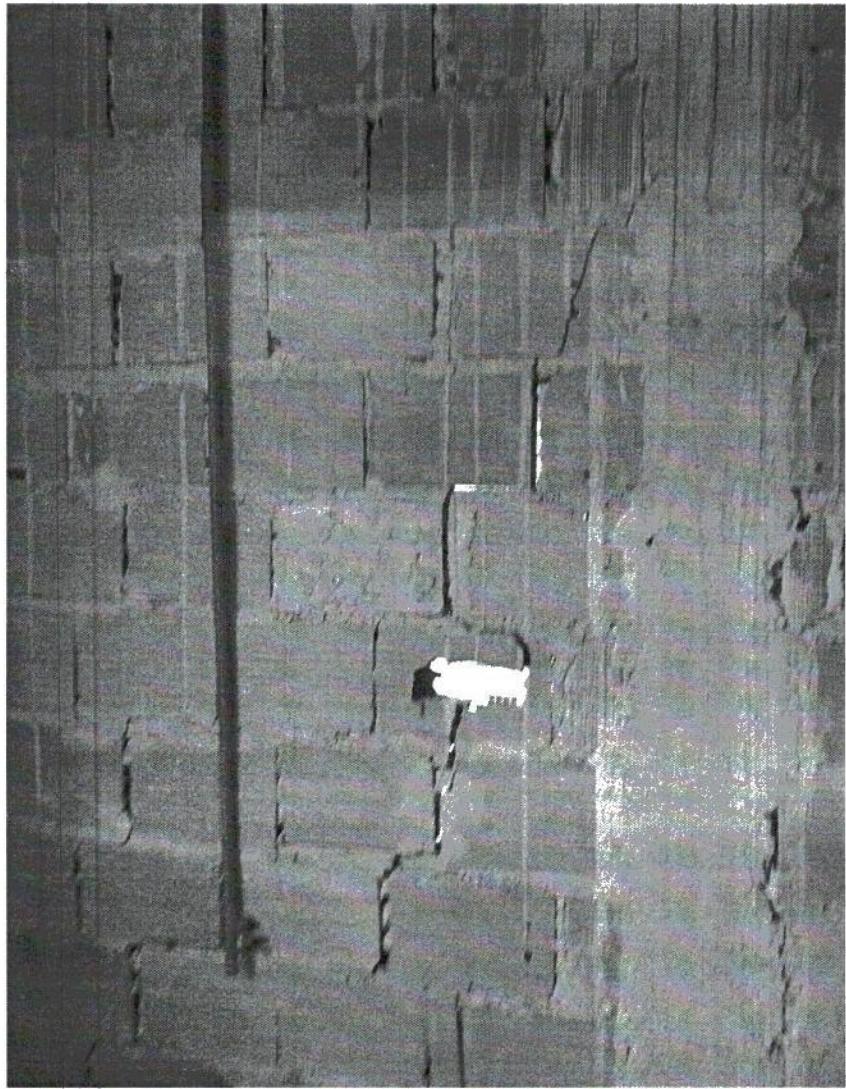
Patologias observadas na estrutura da edificação em construção relacionadas à movimentação do terreno.
